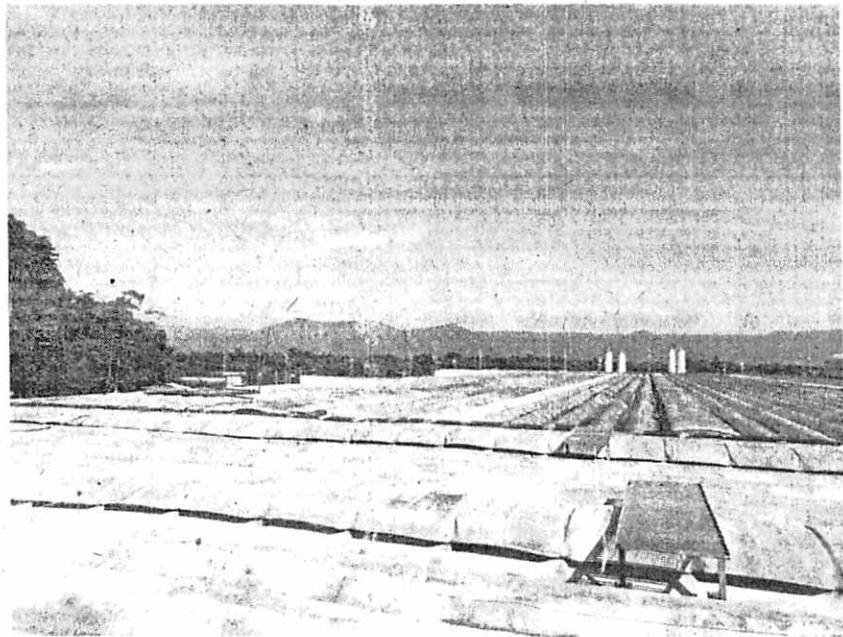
Vista Geral do telhado do supermercado vistoriado.
